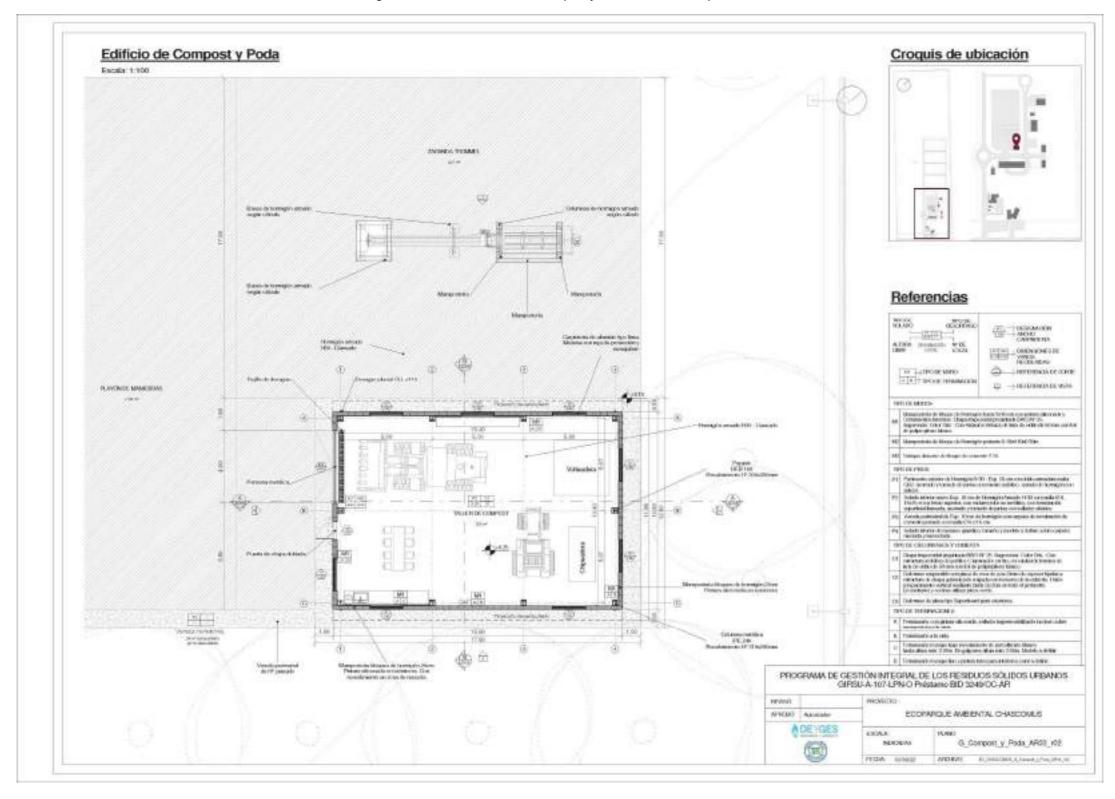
DEtalle del edificio de Compost y Poda - Planta de Arquitectura.
